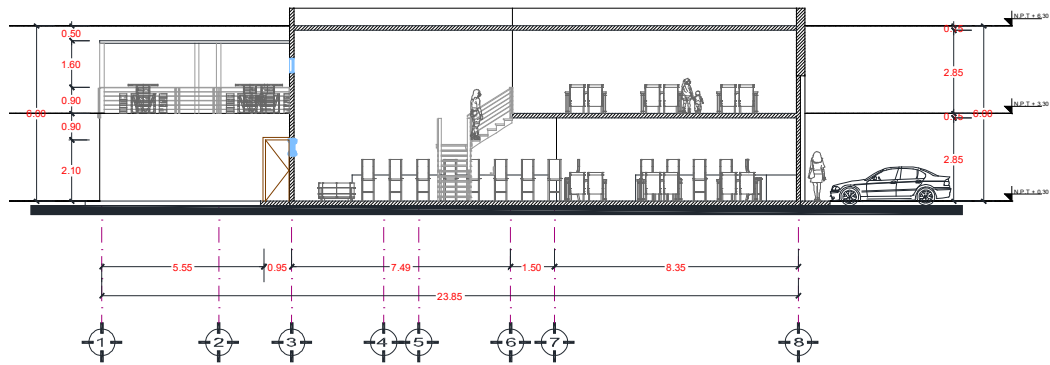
Propuesta Restaurante, Sección A-A' (Anexos Plano: 5-CORT-REST-01)
